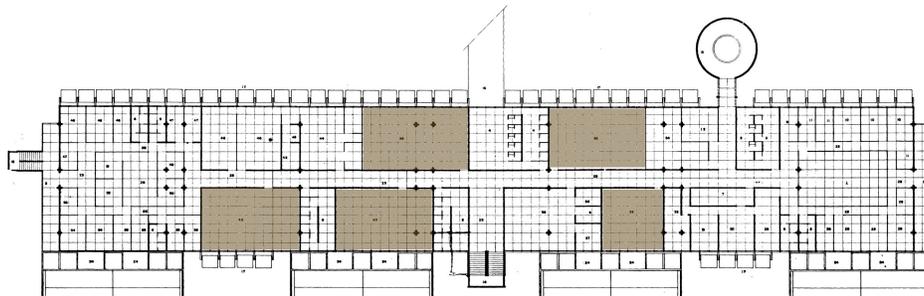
Planta do segundo pavimento, localização das salas de aulas
